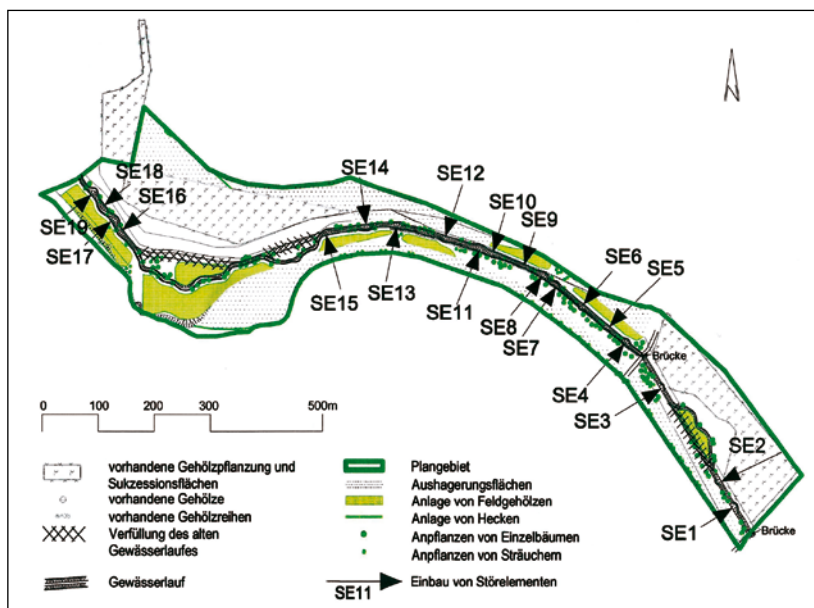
Lageplan des Bauabschnittes 1 zur ökologischen Sanierung eines Klosterbachabschnittes
